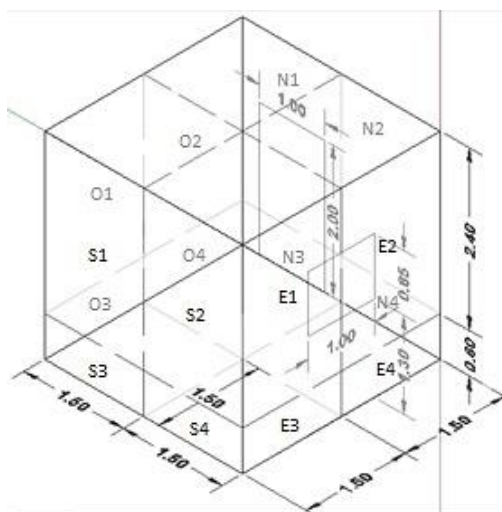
Secciones para cada fachada del módulo de vivienda.
